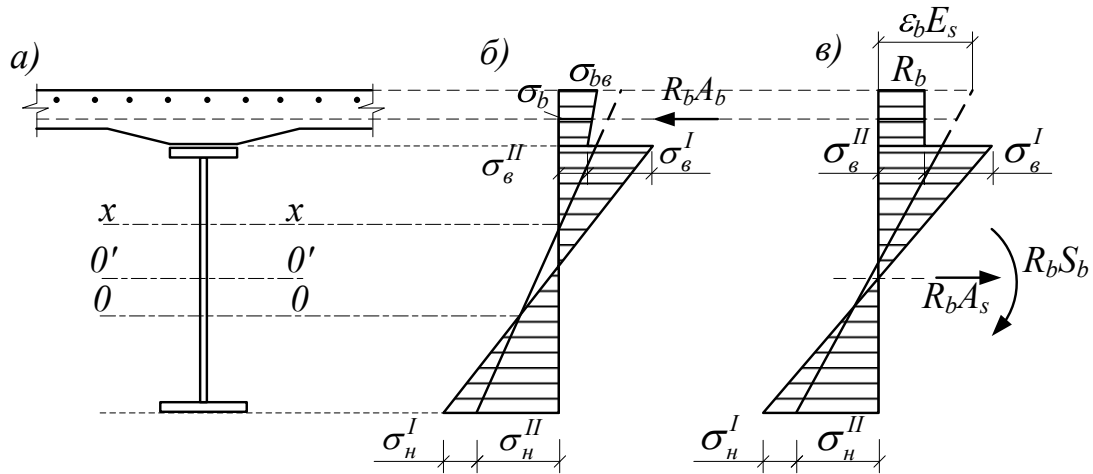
Епюра напружень по висоті сталезалізобетонного перерізу балки жорсткості.
